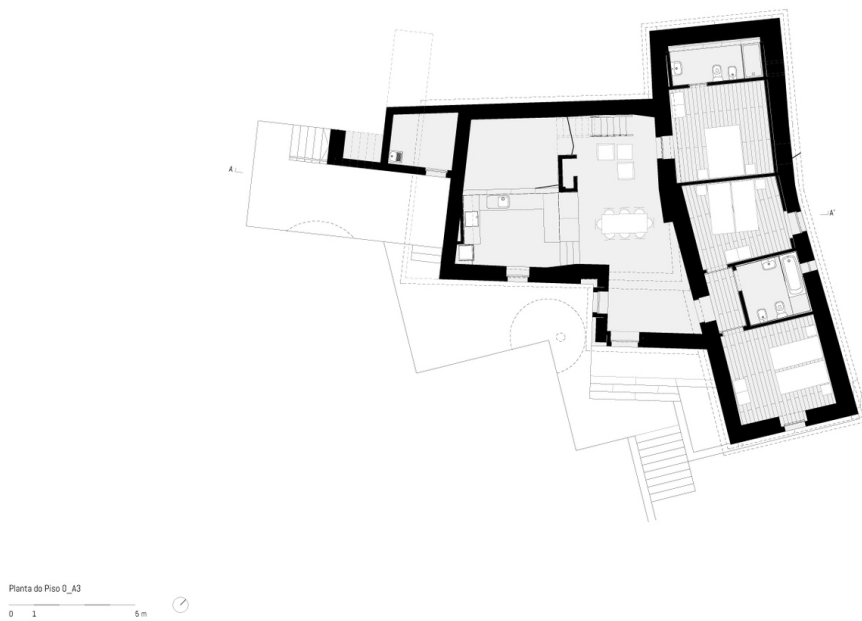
Planta do Piso 0 A3 - Casas do Trebilhadouro
